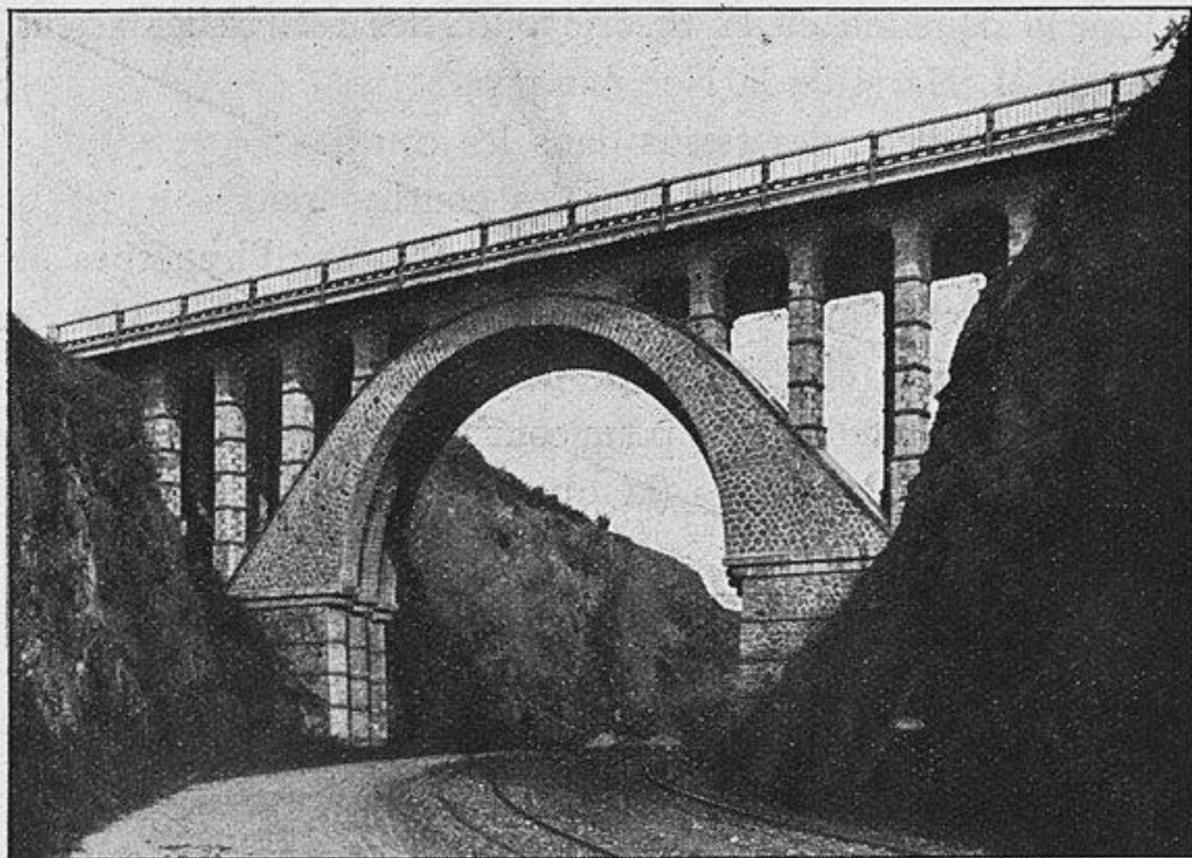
Ligne de Saint-Brieuc à Plouha. — *Pont de Rohannet* (construit en 1905). Pont biais, constitué par trois rouleaux en maçonnerie de 0 m. 70 de largeur, ouverture 20 mètres. Piliers en maçonnerie. Tablier en béton armé.
